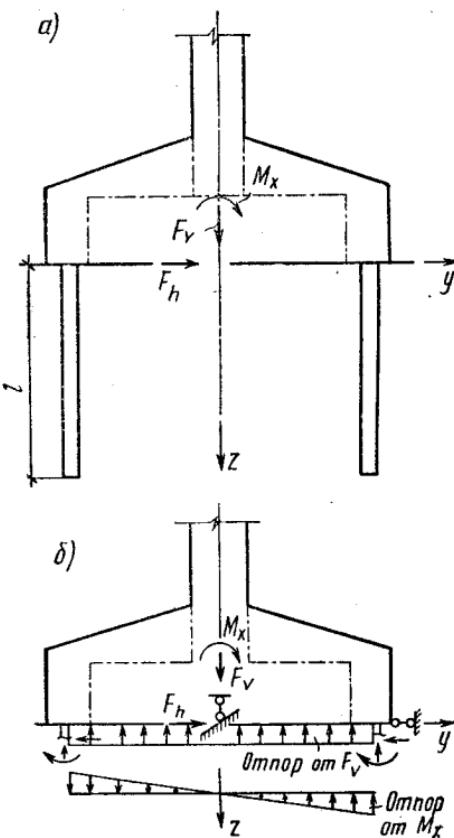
Модель расчета усиленного фундамента на естественном основании:
